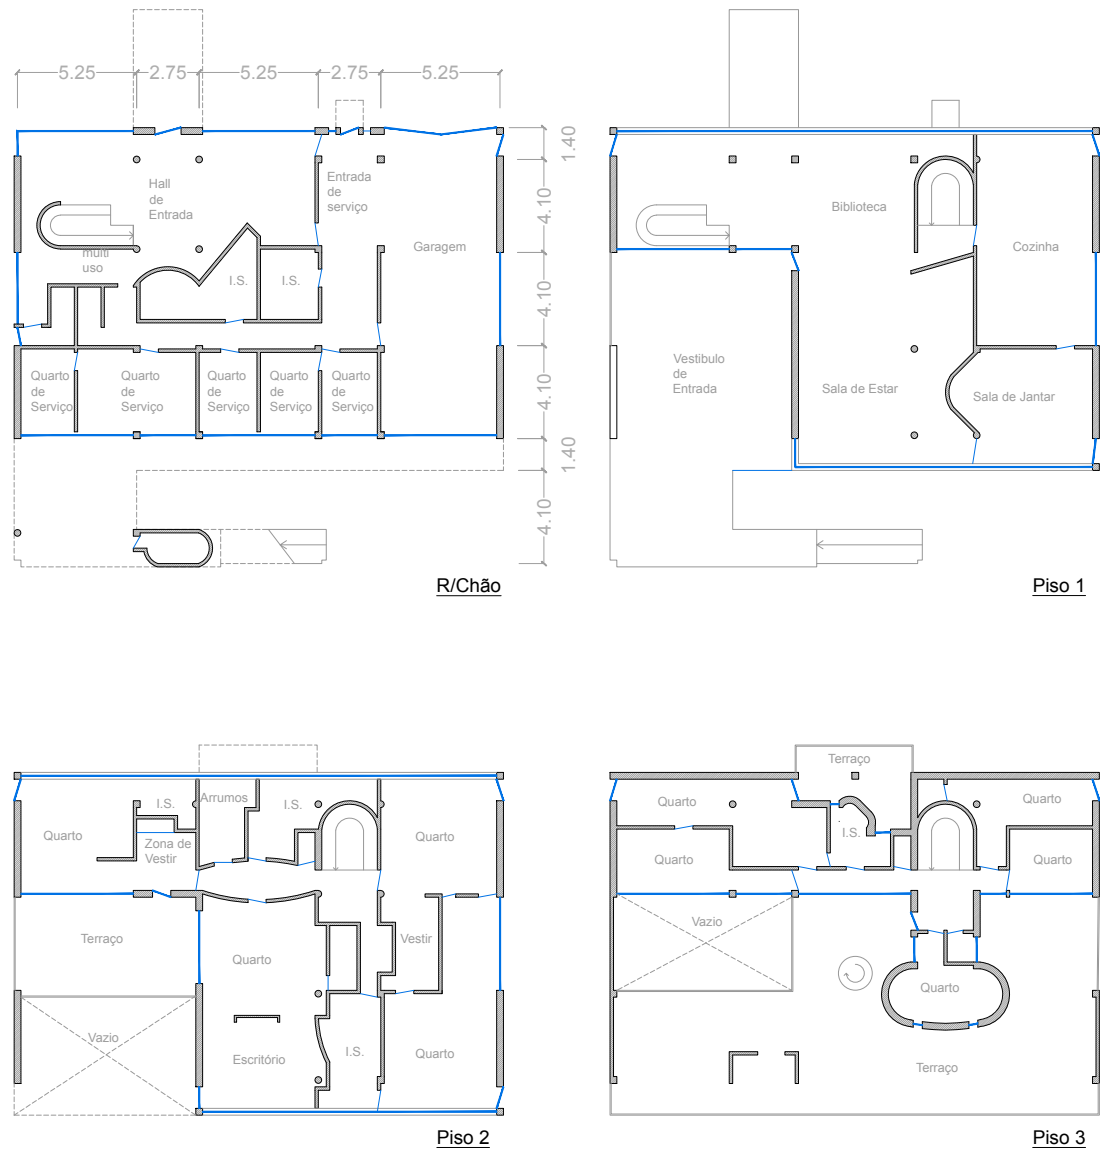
Dimensões dos espaços da Villa Stein (ilustração do autor)
